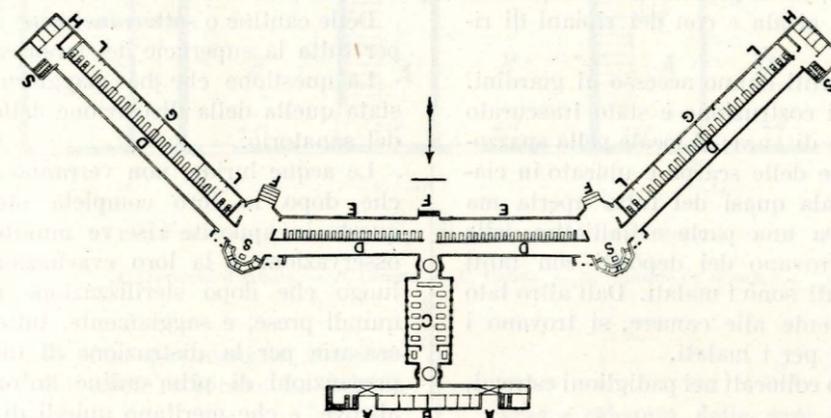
Pianta del Sanatorio di Bligny (piano terreno sopraelevato).
